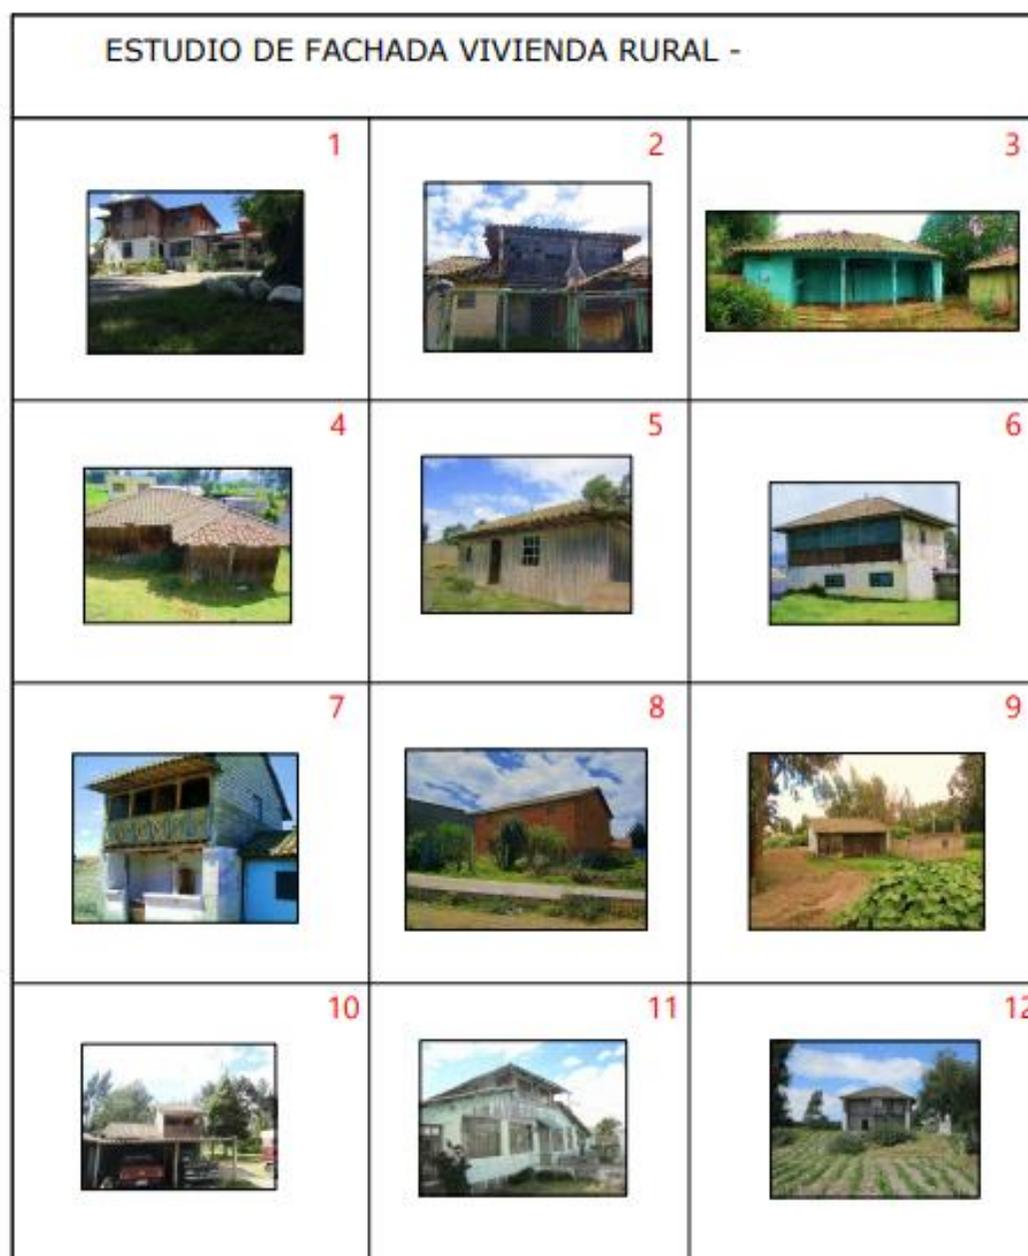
Levantamiento fotográfico de fachadas de las viviendas en estudio. Fuente y elaboración: Propia
